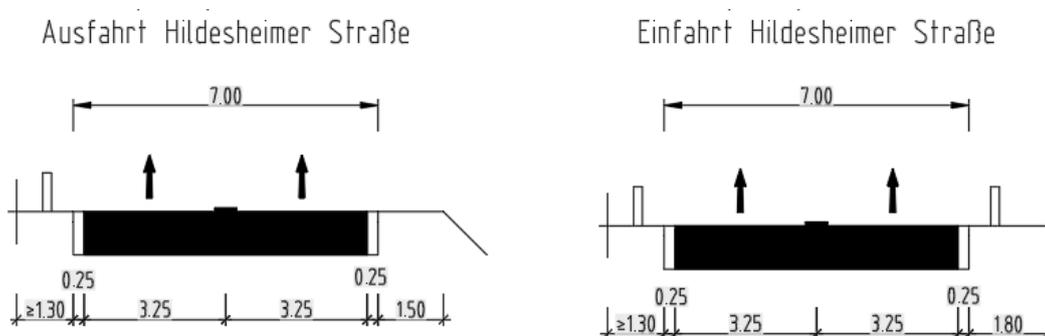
Rampenquerschnitt RRQ 2 Hildesheimer Straße
